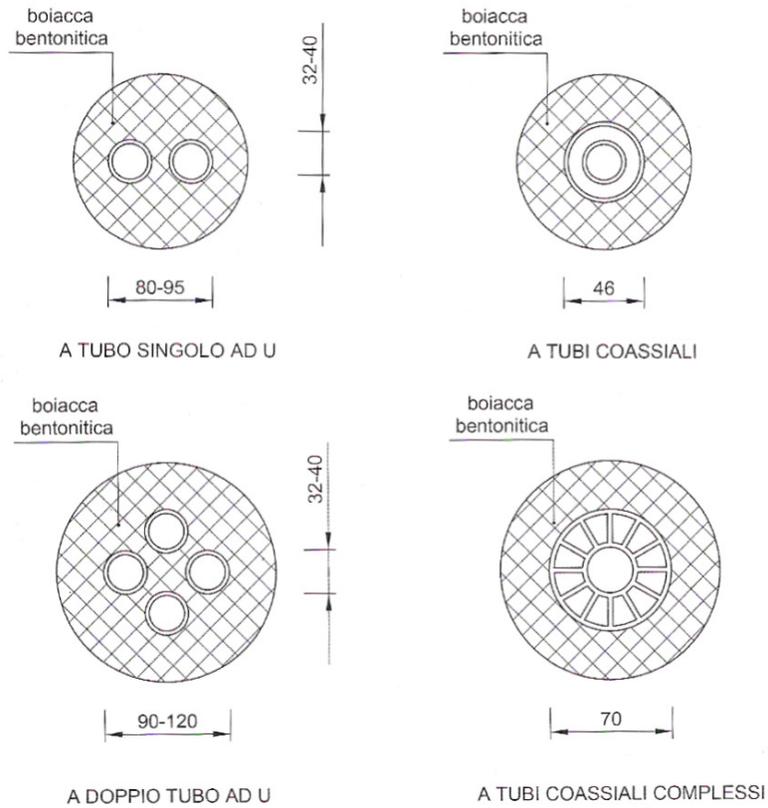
Sezione trasversale delle sonde geotermiche verticali [3]
